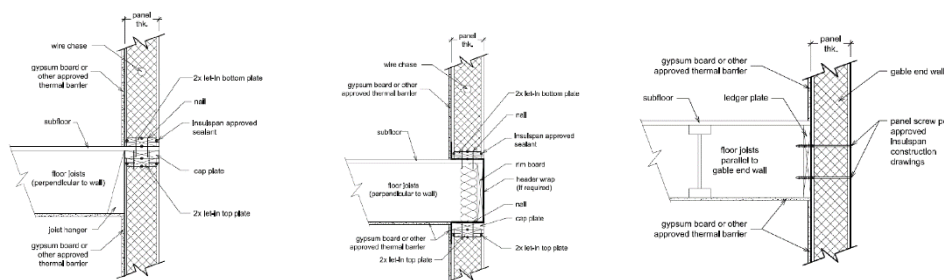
Ligações entre pavimento elevado e parede exterior (INSULPAN, 2015).
